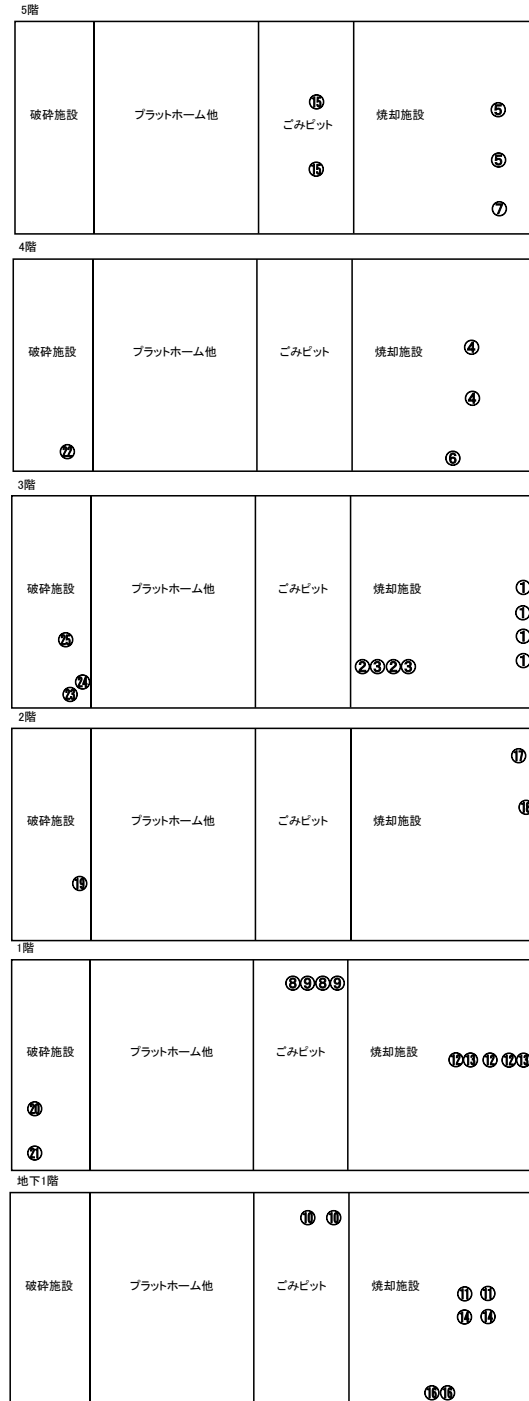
騒音を発生させる主要な設備機器の配置図(平面図)
